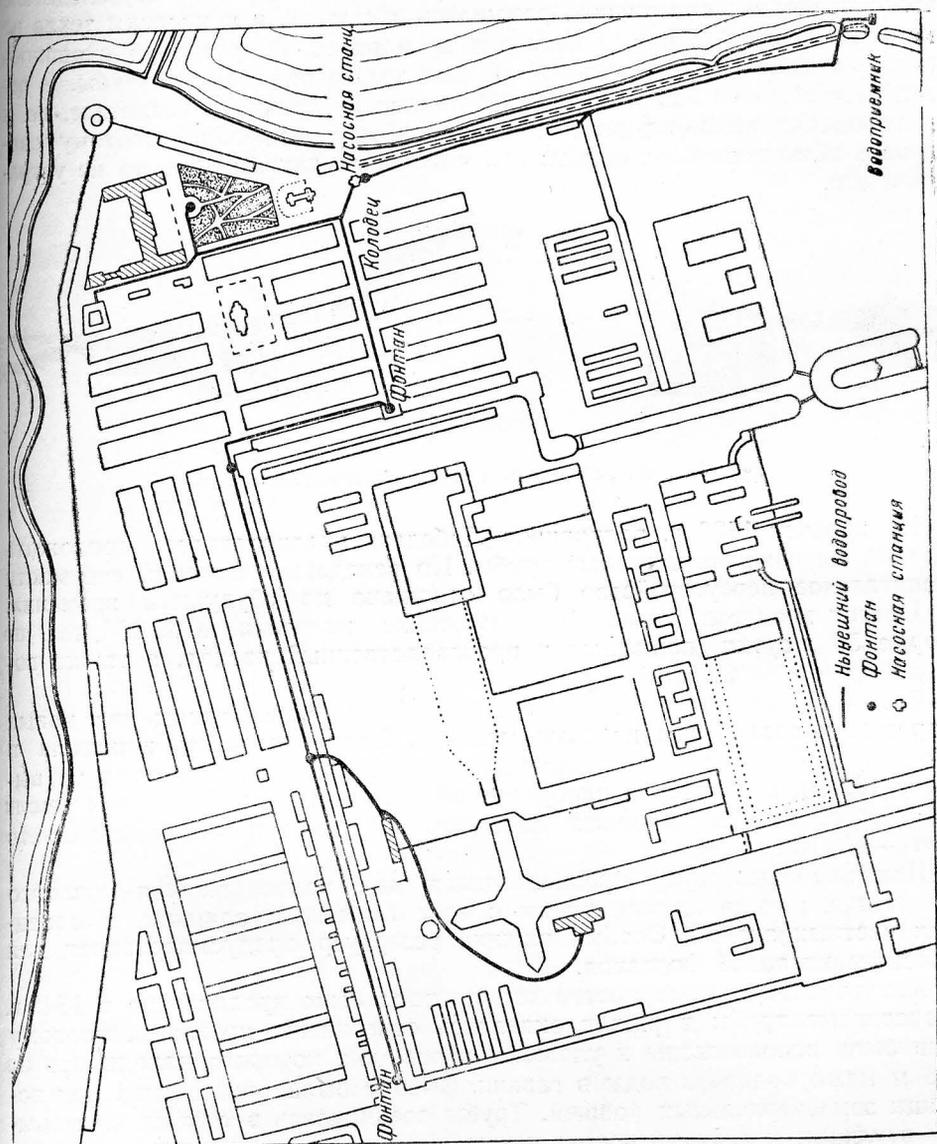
План кронштадтского водопровода («Инж. Журн.», 1864 г.).
